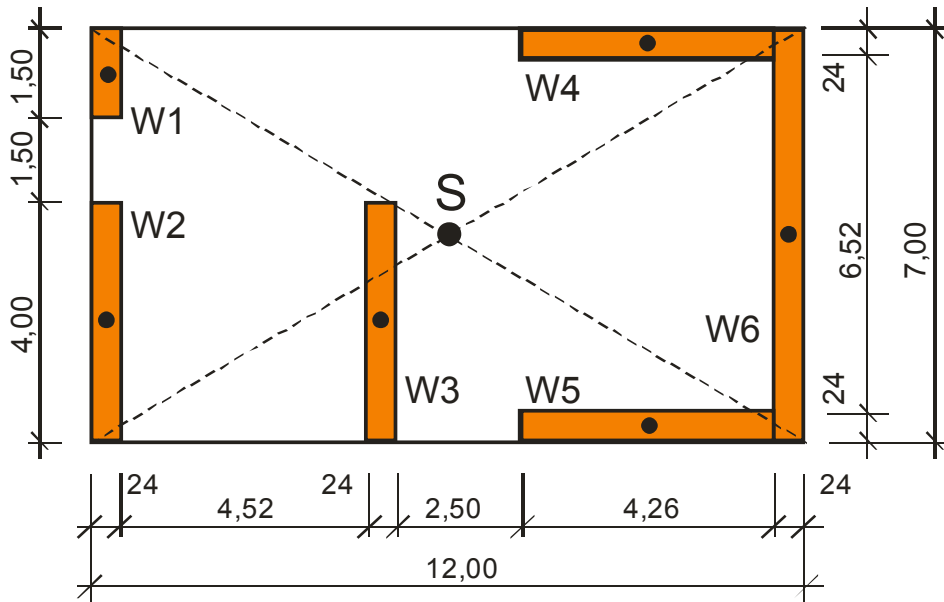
Grundriss des mehrgeschossigen Hauses der Beispiel-Aussteifungsrechnung 1
